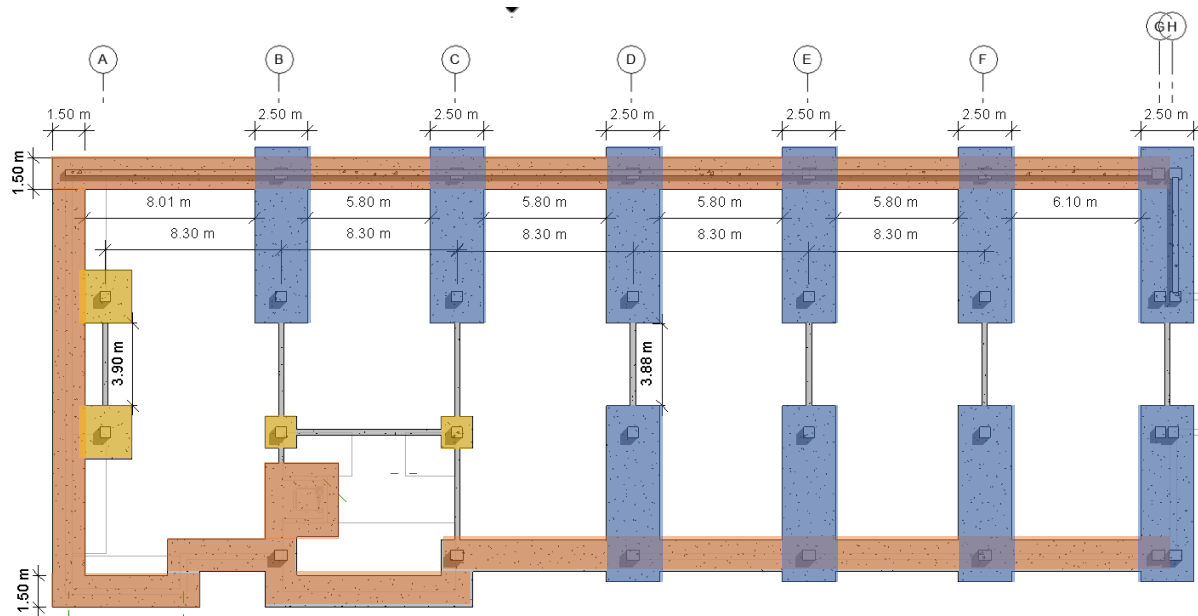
Ubicación de cimentaciones en el Proyecto Residencial Urban Flats.
